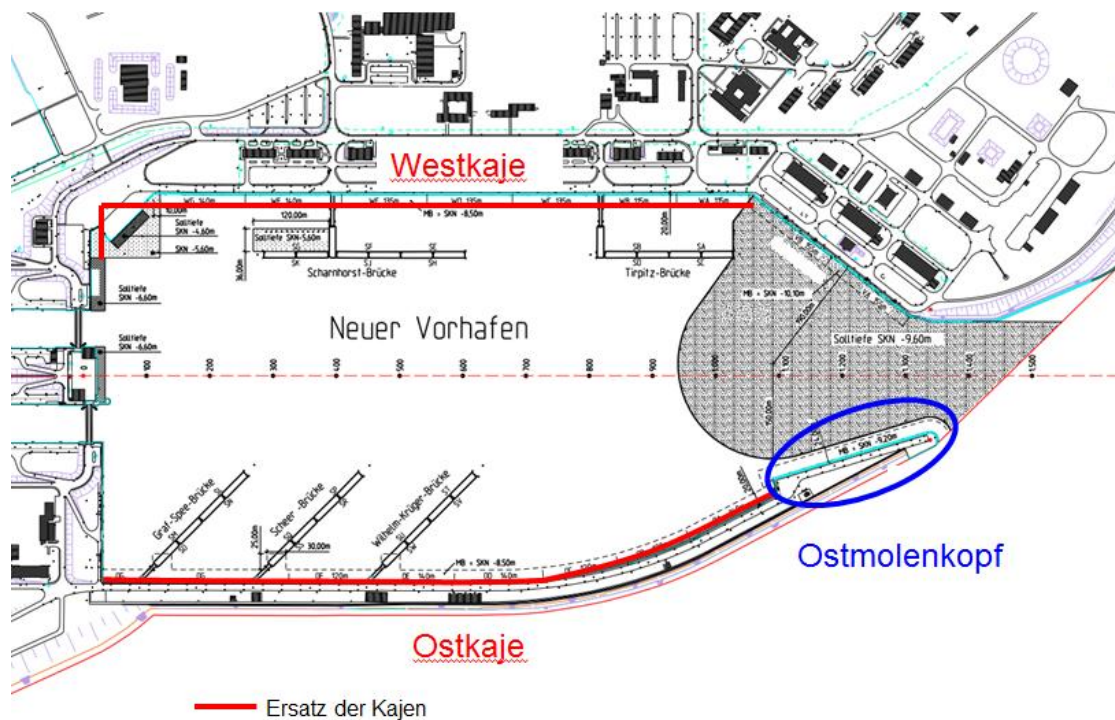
Lageplan Neuer Vorhafen Wilhelmshaven
